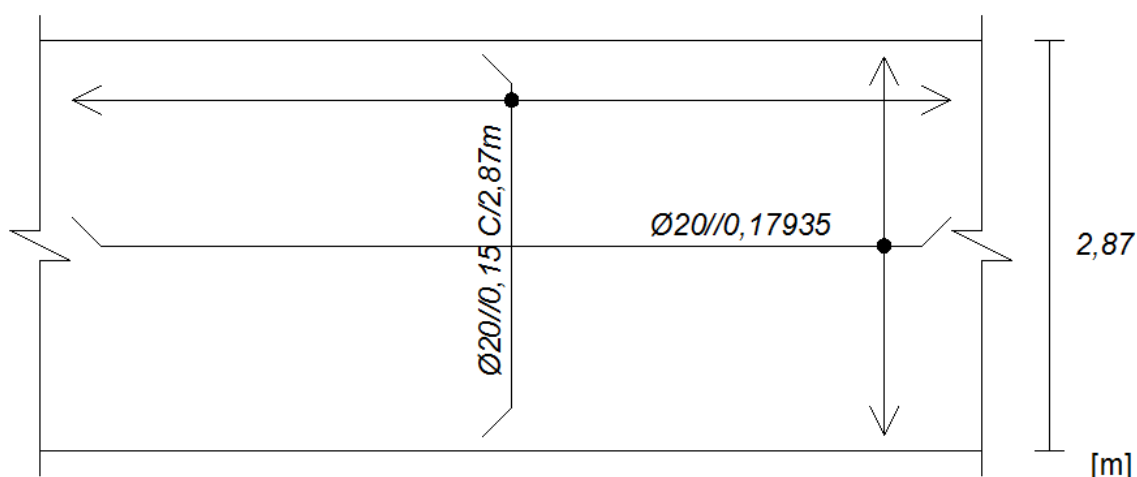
Pormenorização das armaduras ordinárias em planta, da laje com armadura ordinária inferior (Marques, J. 2013)
